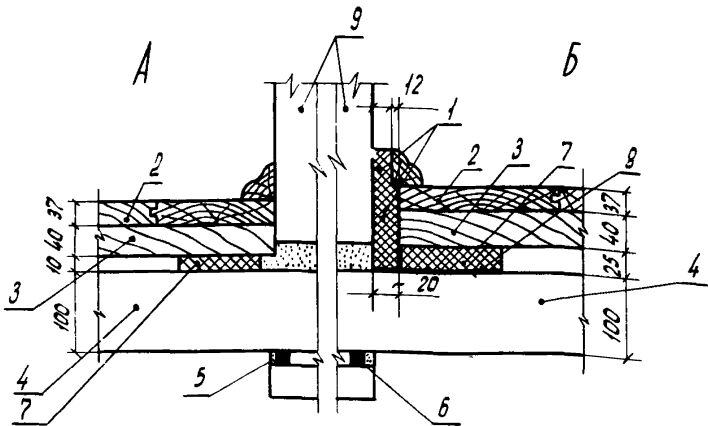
Звукоизоляция перекрытий в домах серии I-464А-20 И: А - по проекту, Б - после ремонта, 1 - звукоизоляционные прокладки, завернутые в воздухопроницаемую бумагу; 2 - доски пола, 3 - лаги, 4 - панель перекрытия, 5 - цементный раствор, 6 - порошол, 7 - звукоизоляционные прокладки под лаги из древесно-волокнистой плиты, 8 - слой толя, 9 - внутренняя стена.
